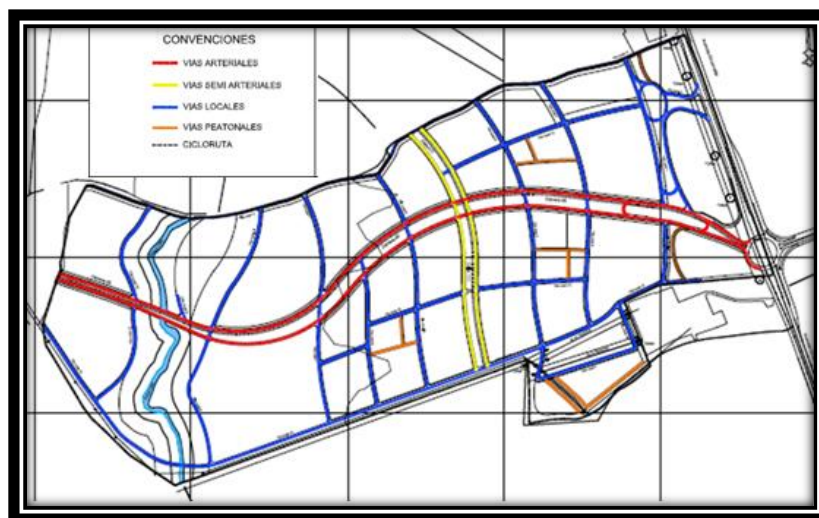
Plano Red Vial Plan Parcial “El Volador”
